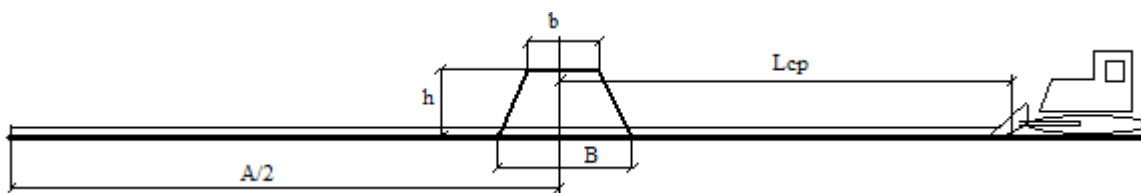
Расчетная схема срезки растительного слоя. L_{cp} – среднее расстояние перемещения растительного грунта при обваловке, h – высота отвала грунта, A – полоса расчистки растительного грунта, B – ширина отвала растительного грунта по низу, b – ширина отвала растительного грунта по верху.
